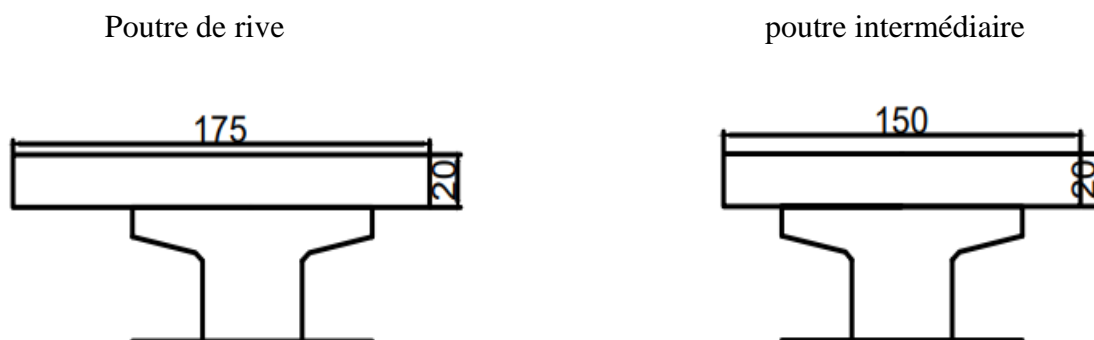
POUTRE INTERMEDIAIRE ET POUTRE DE RIVE
